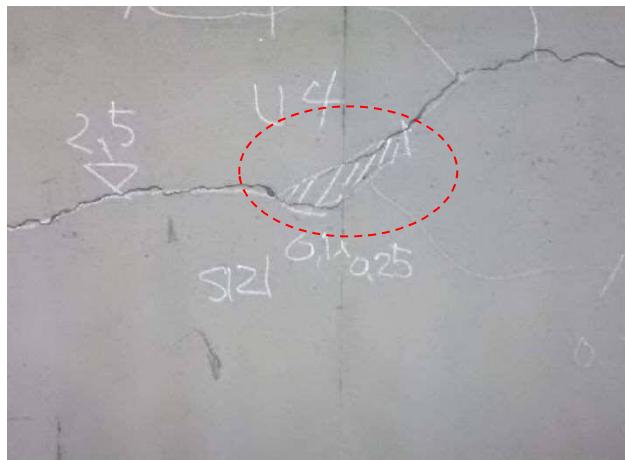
縦断方向ひび割れが進展したうき
